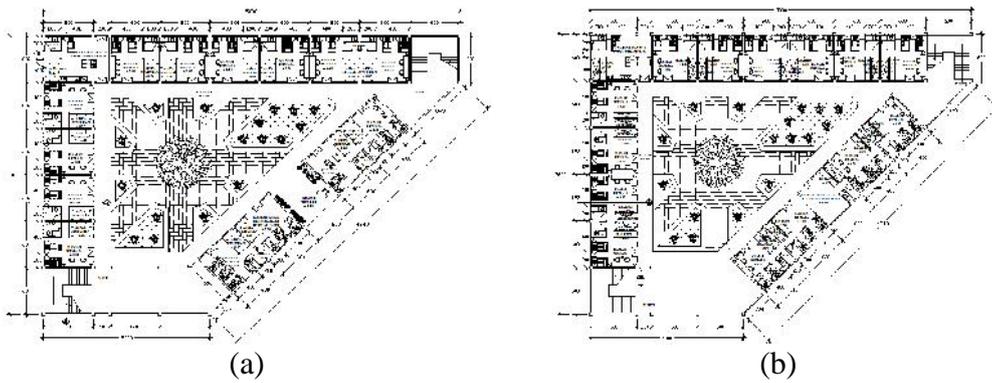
a) Denah Lantai 1 bangunan utama b) Denah Lantai 2 bangunan utama
